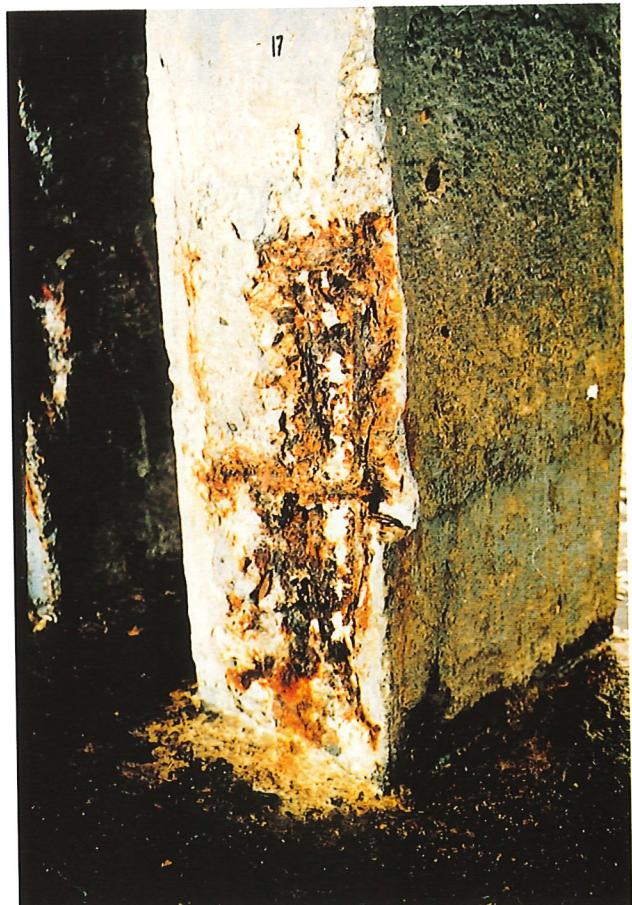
Daños por lixiviación (deslavado) del hormigón y corrosión en la cara inferior del tablero de un muelle.
